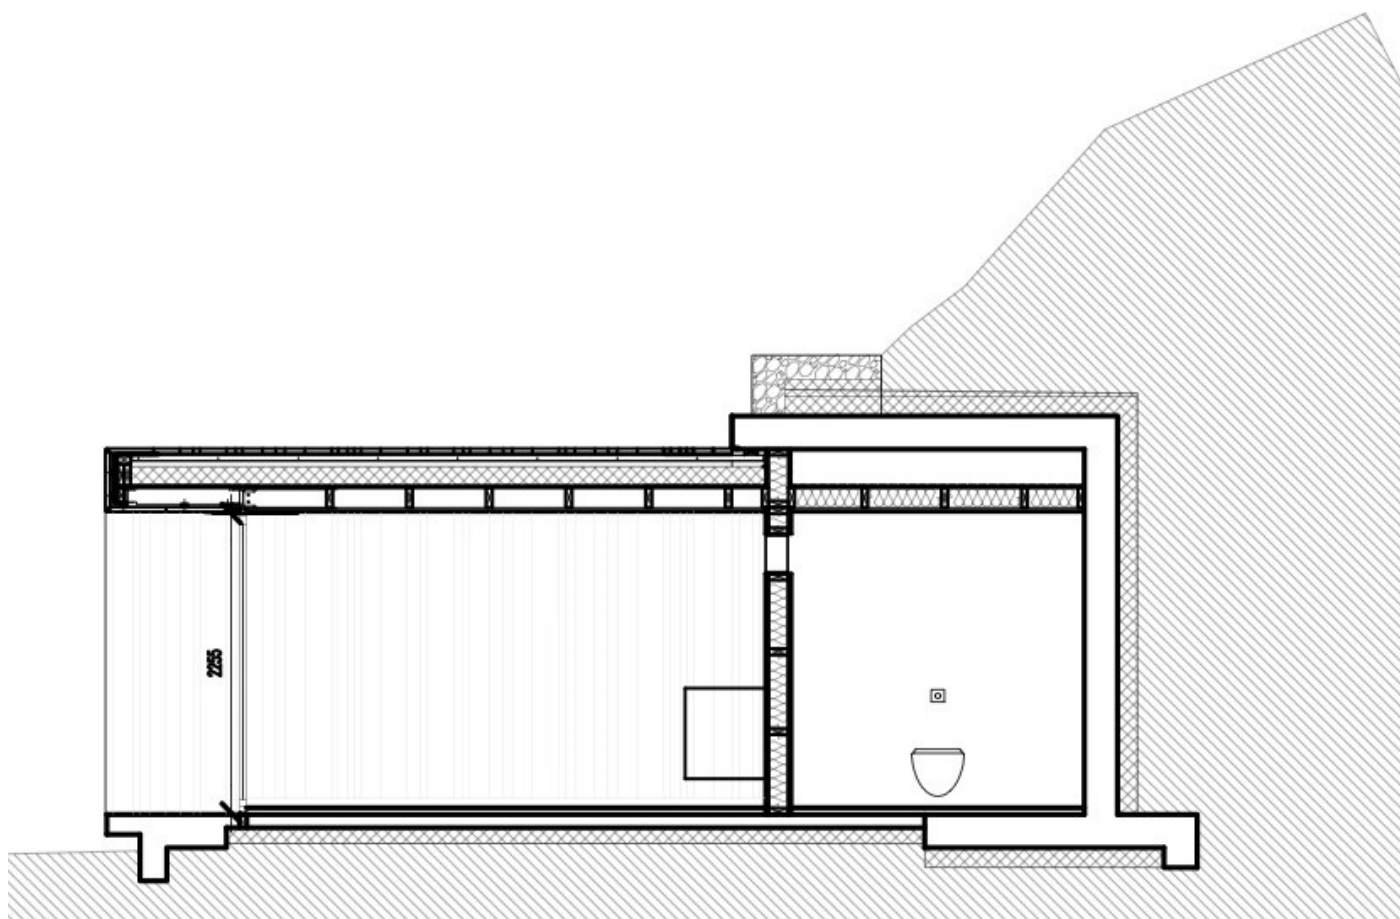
Sección constructiva del centro de visitantes. En esta se puede apreciar el muro de hormigón armado de contención de tierras, así como la losa de hormigón armado inferior y superior. Las divisiones interiores en madera CLT y los cerramientos en madera también se detallan en esta imagen.
